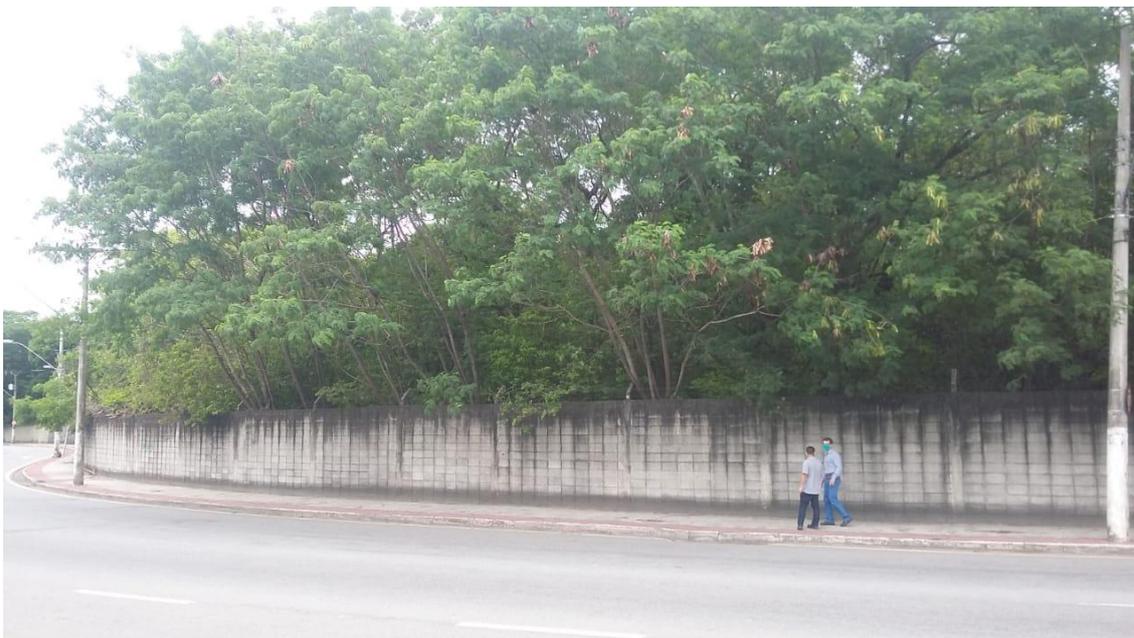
Parte frontal da gleba B cercada por muro de bloco de cimento.
